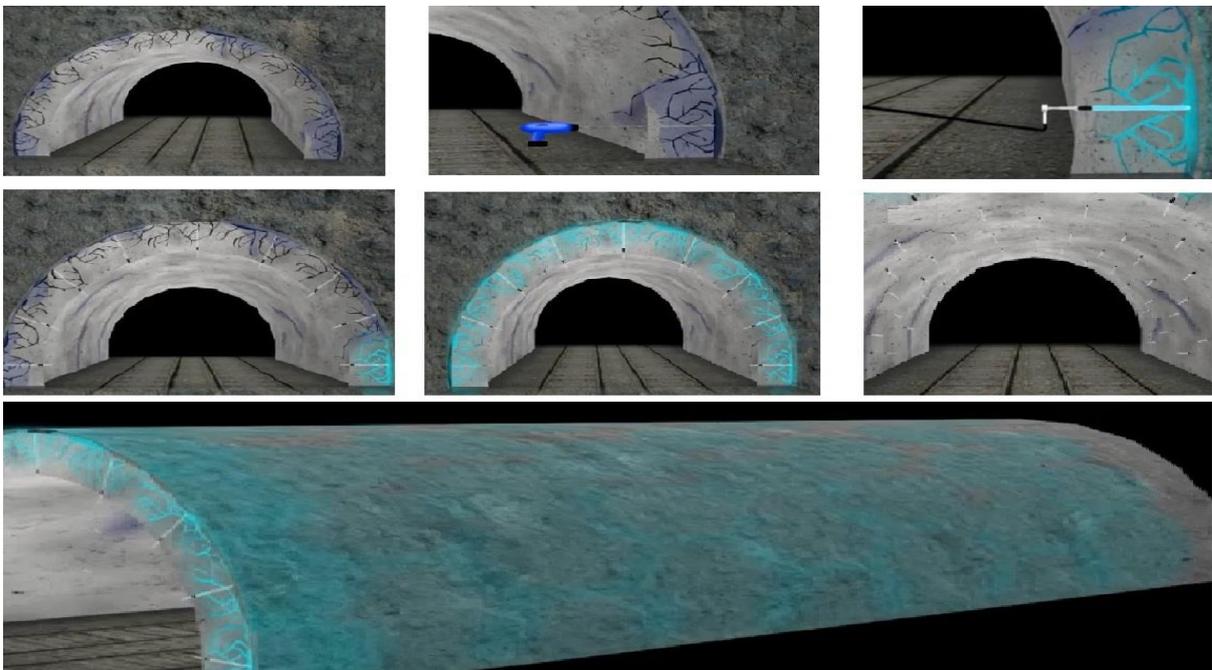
Technologiestufen bei Schleierinjektionen im Tunnelbau¹⁵⁰
